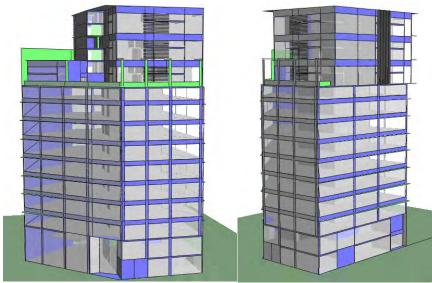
Modelo 3D proyecto propuesto vista sur y oriente
